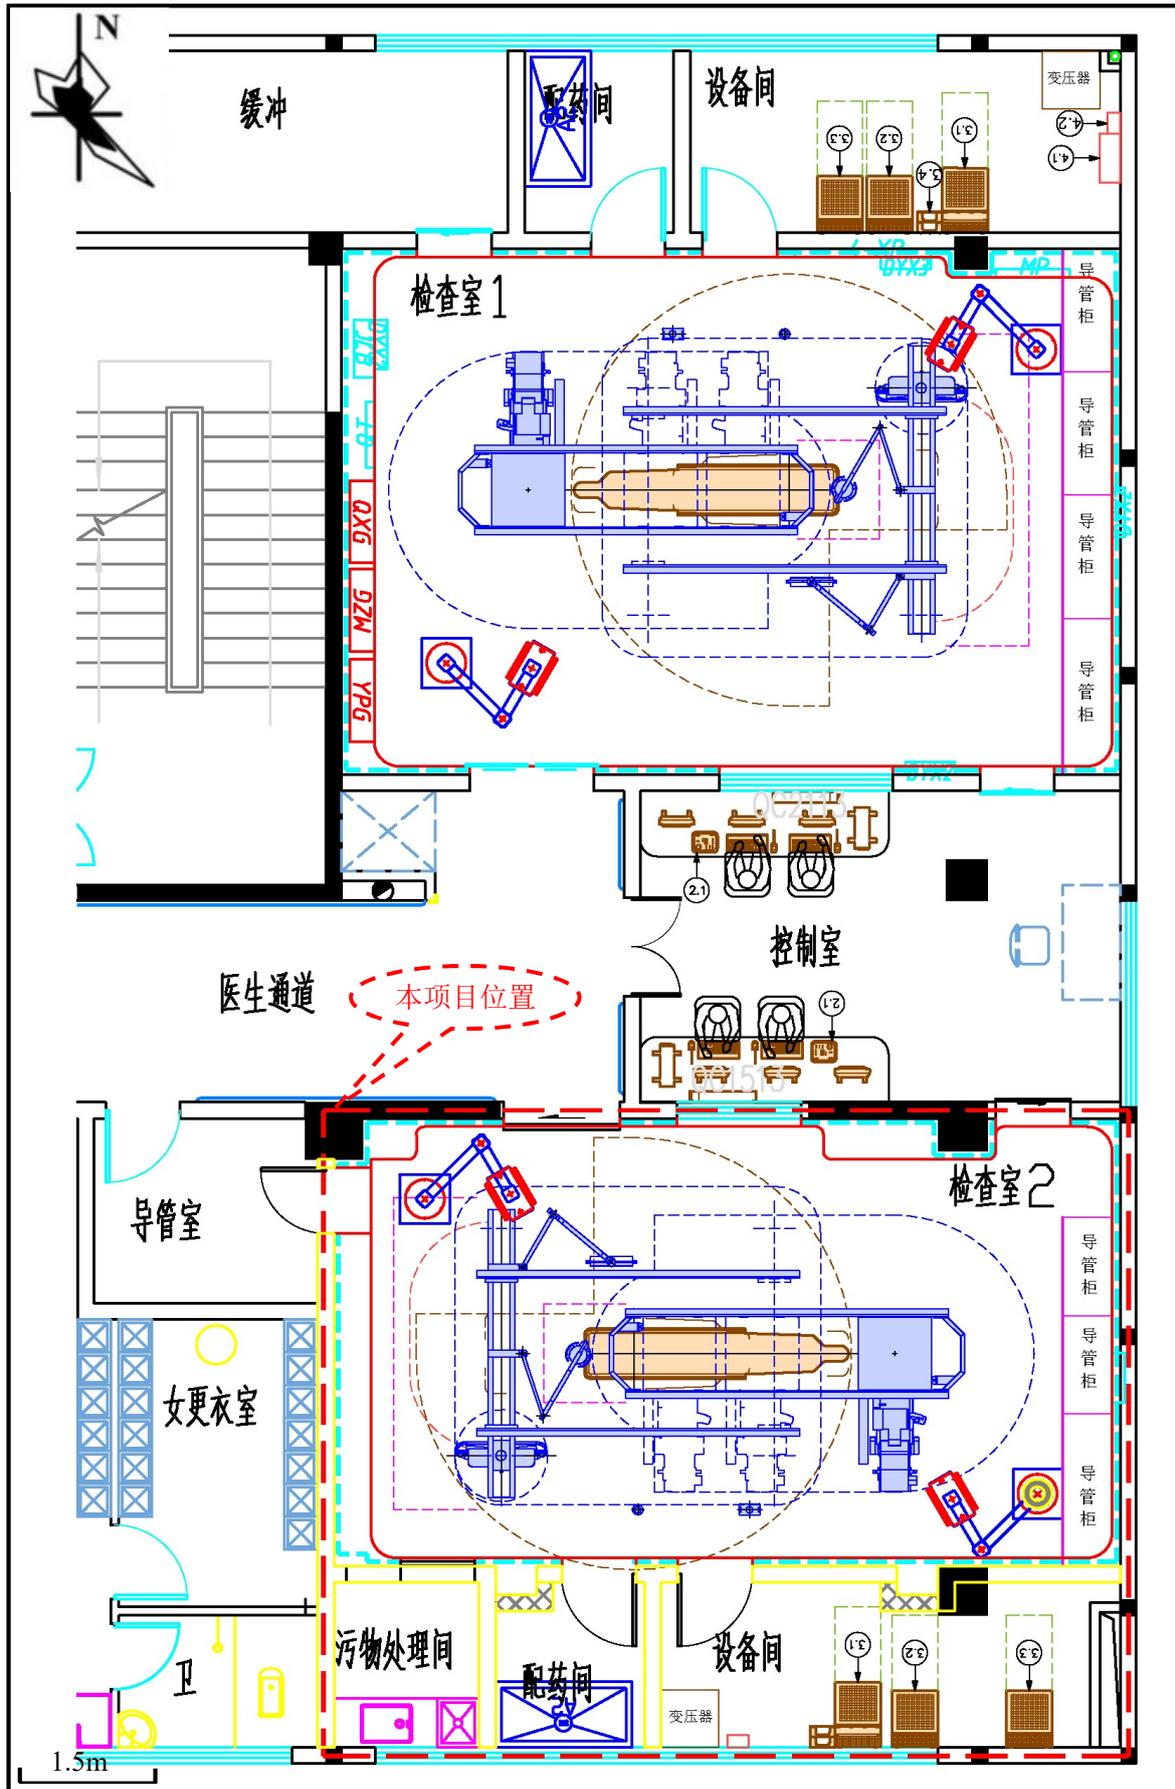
福建省肿瘤医院内科大楼 3 层（局部）平面布置图
